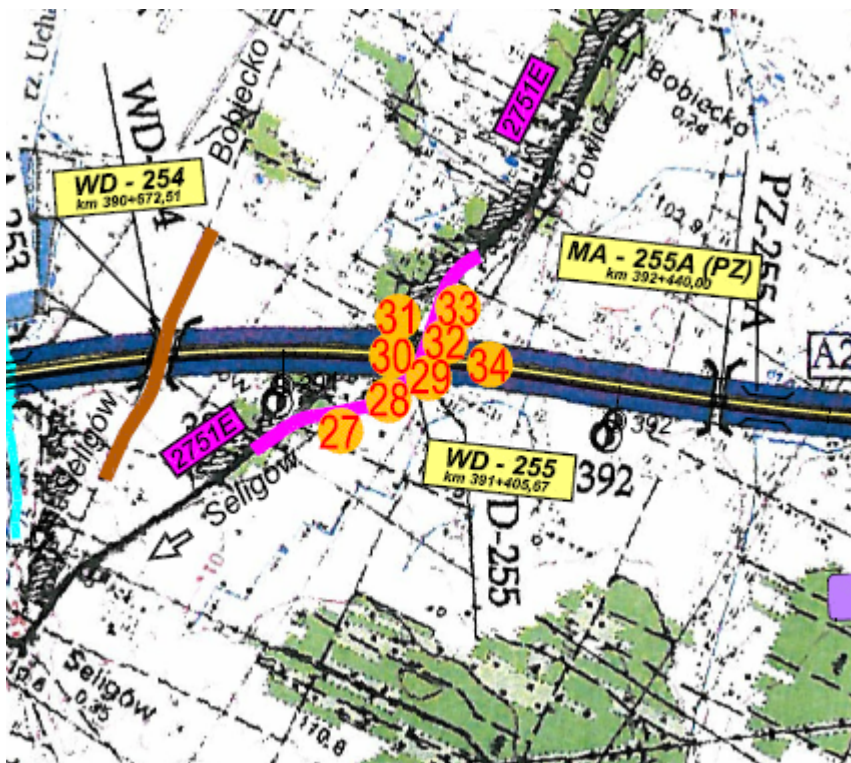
Plan orientacyjny planowanych rozbiórek (nr 6-7)
